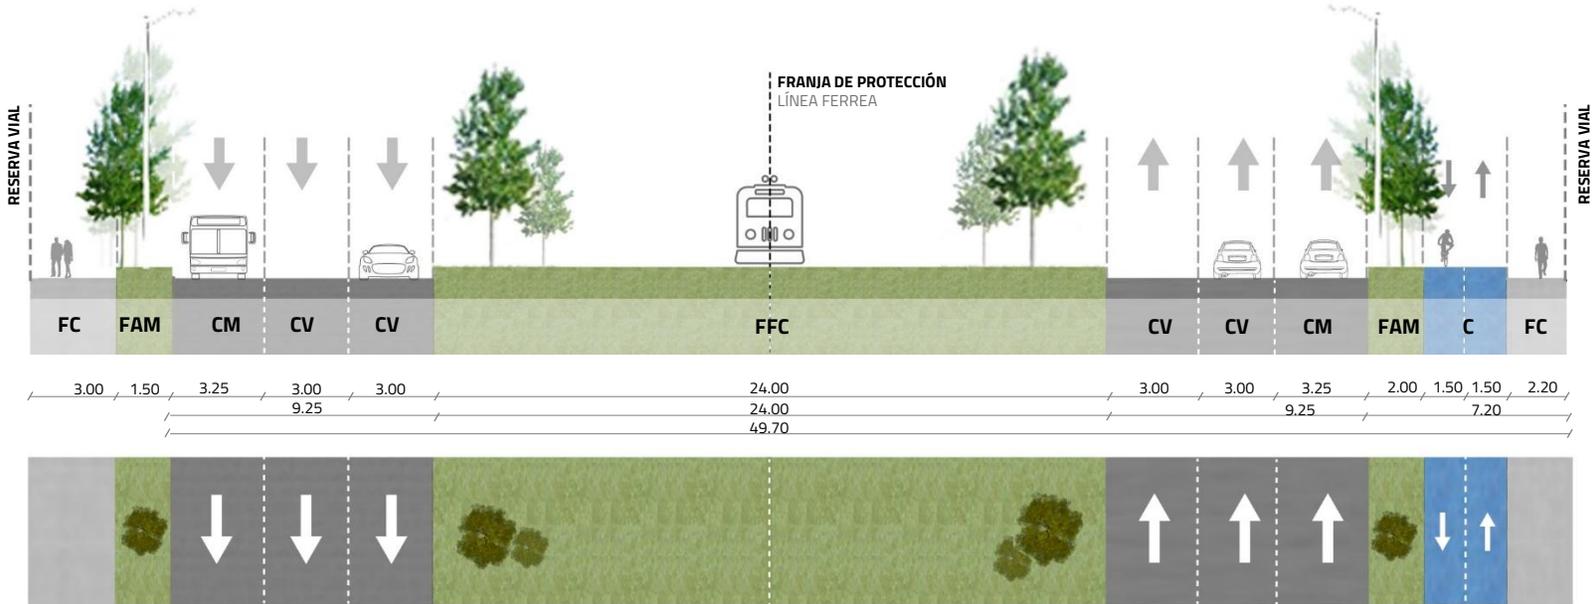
Perfil Av. Ferrocarril del Sur Fuente: Elaboración Propia
